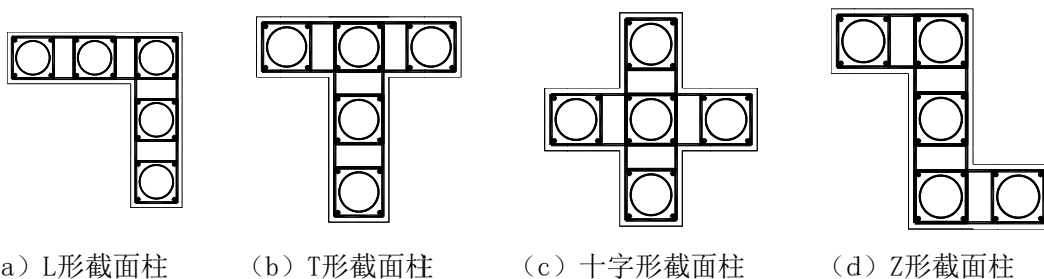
异形柱内钢管、钢筋布置形式
